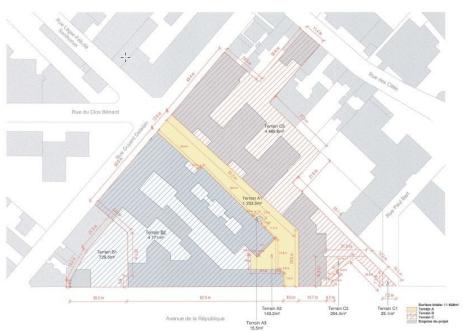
Plan de division du terrain (source : plan de division, permis de construire)
